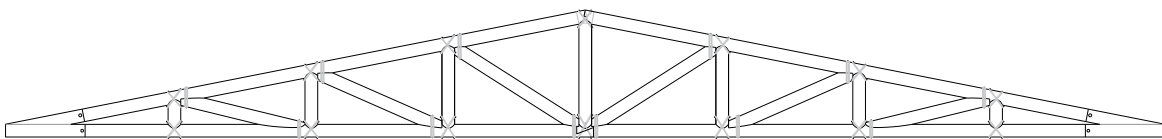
Imagen de cómo podría lucir la estructura de bambú.
